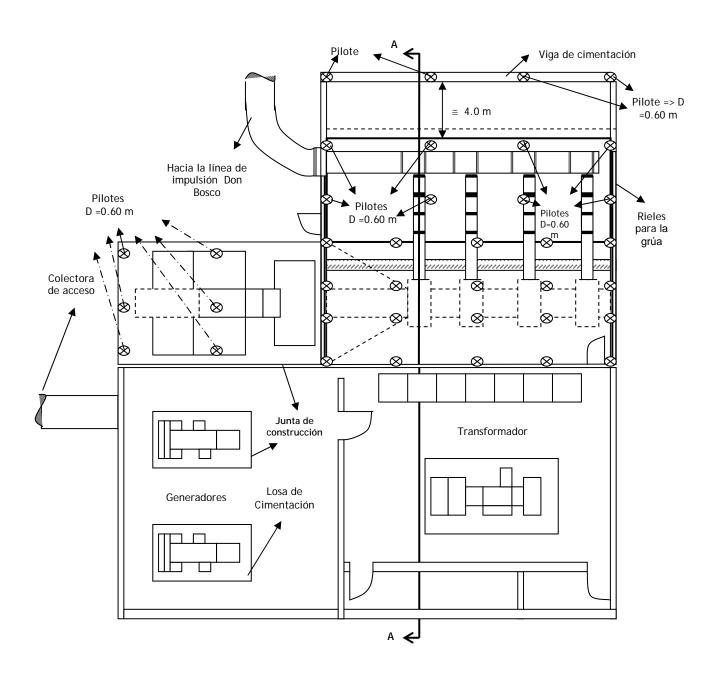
Estación de Bombeo Tocumen - Vista en Planta
